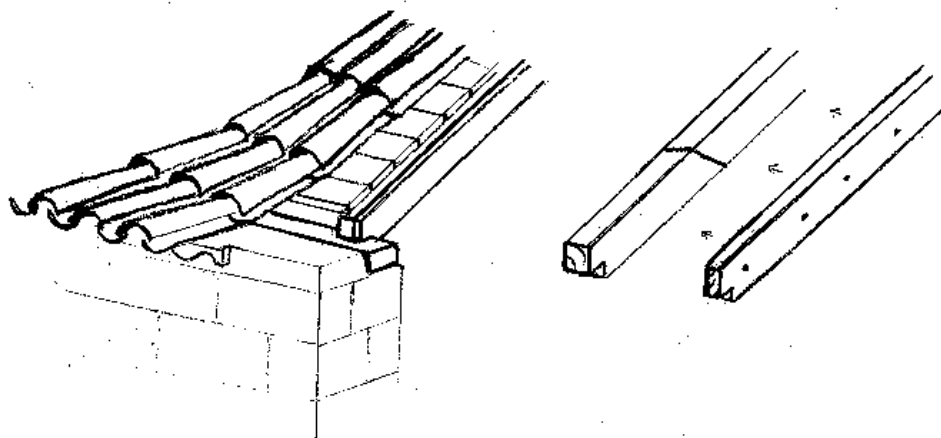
Empalme de elemento de madeira numa das faces laterais com peça de secção semelhante de madeira tratada, (Fonte: de autor)
